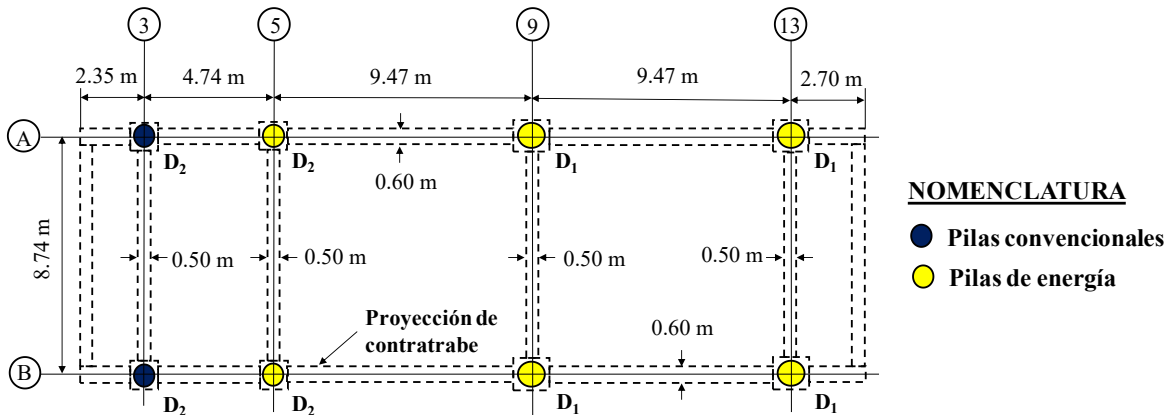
Planta de cimentación del Proyecto C73 (adaptado de López-Acosta y Barba-Galdámez, 2022)
